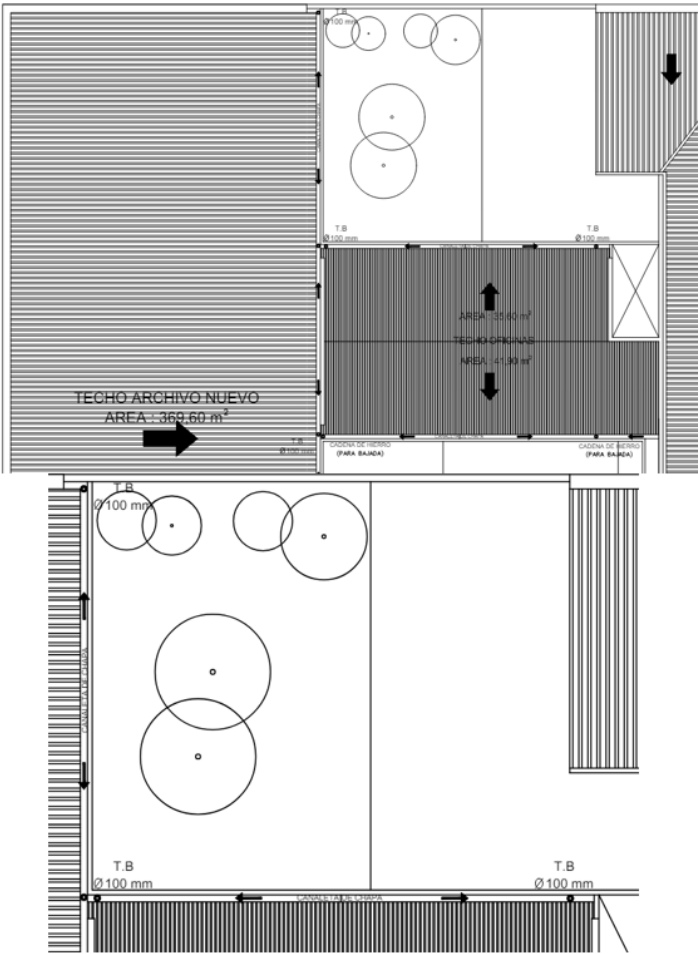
Plano de desagüe de techos y lugares de bajadas
